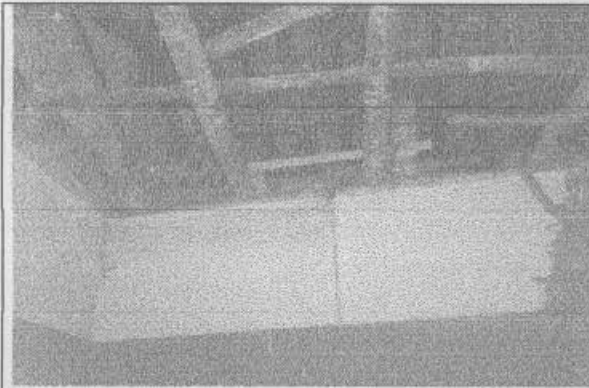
Colapso del cielo raso en algunos sectores de la construcción a nivel de segundo piso.
